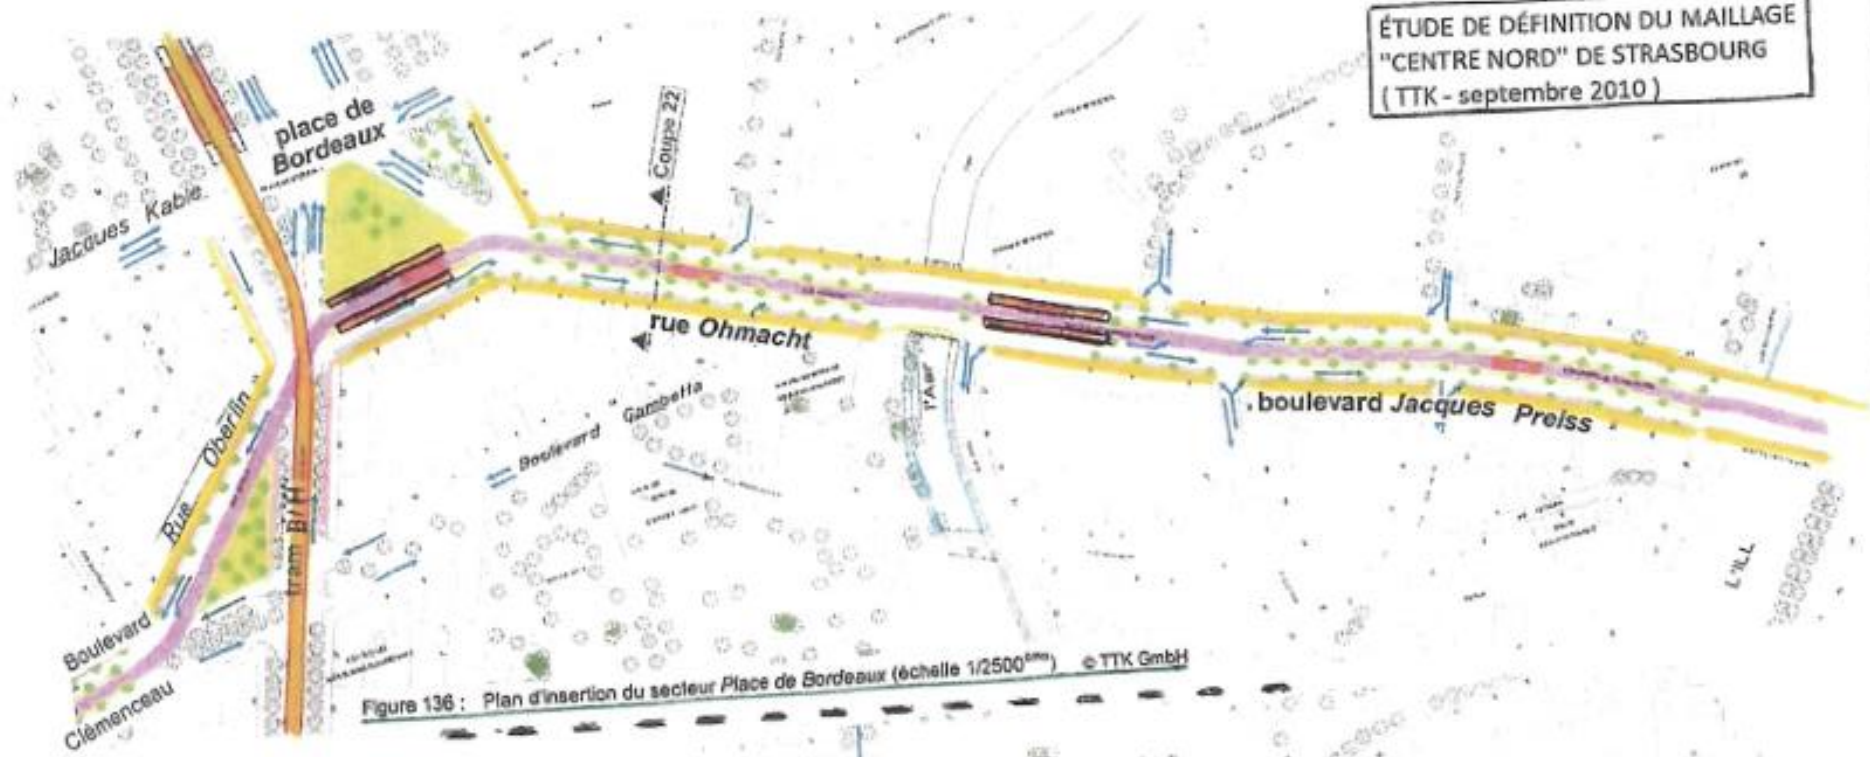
Plan d'insertion du secteur Place de Bordeaux (échelle 1/2500) © TTK GmbH
